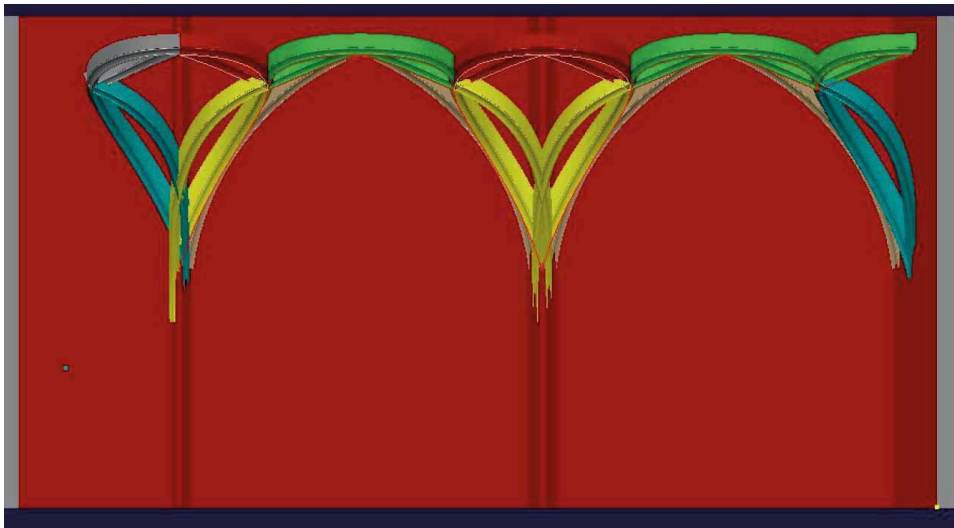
© 2011 Bauer-Lauterbach – Nachkonstruktion Rippenwerk Landhauskapelle nach eigener Vermessung - Längsschnitt
